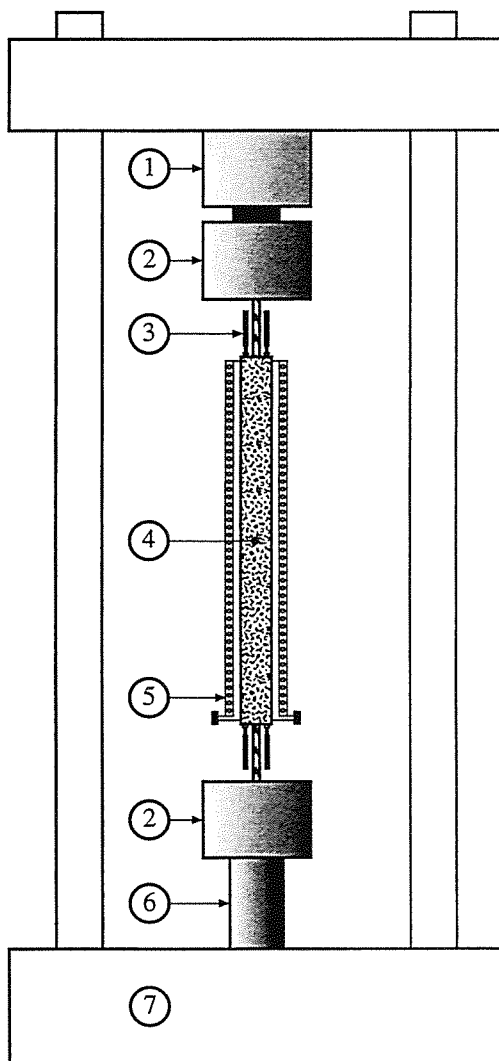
Geometría de las probetas de hormigón con una barra embebida
